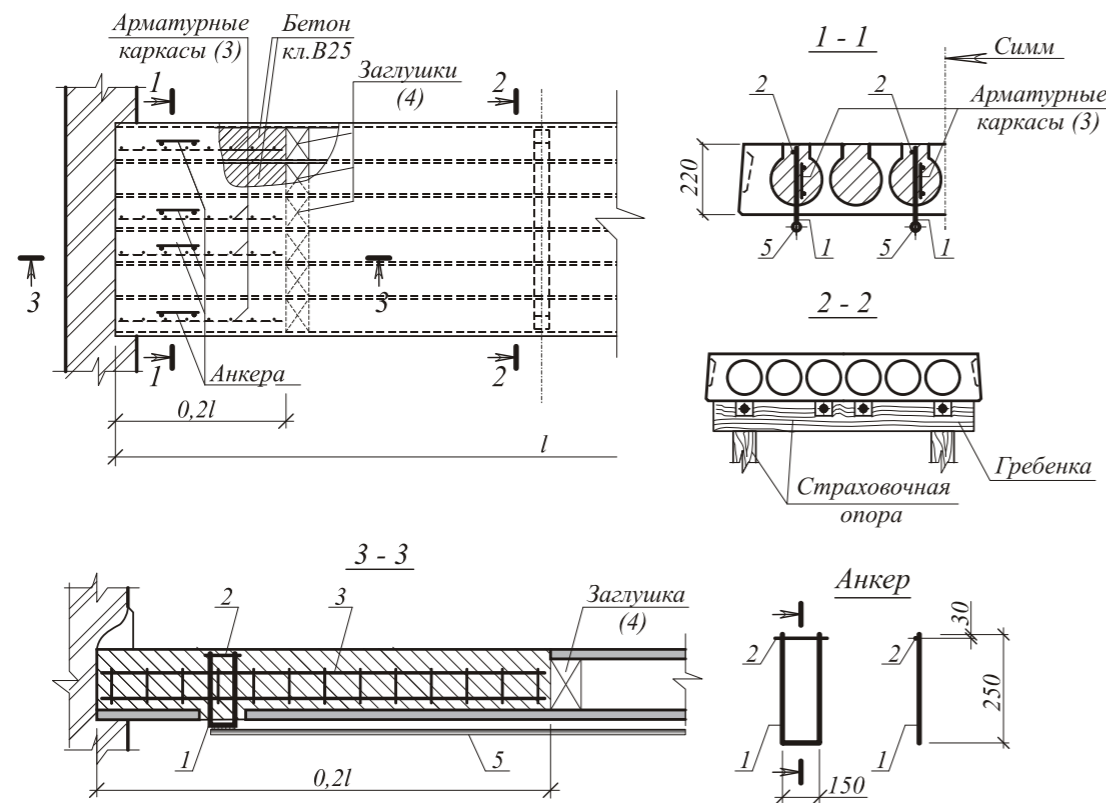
Конструкция усиления пустотной плиты перекрытия
